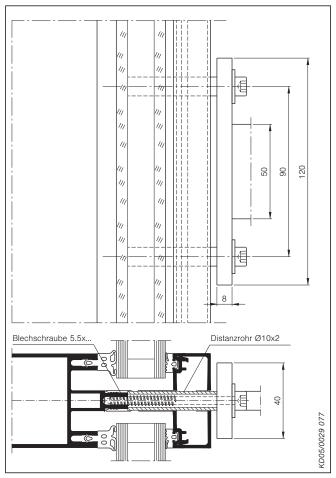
Befestigung des Führungsschienenhalters durch Distanzrohre zwischen Halter und Pfostenprofil
